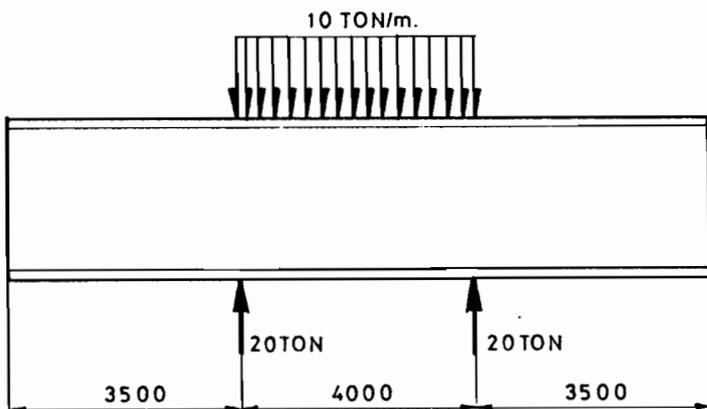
FUERZAS SOBRE VIGA TRANSVERSAL.
